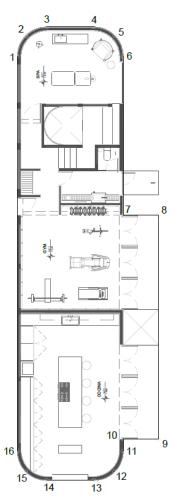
Plano de construcción cocina, spa y Gimnasio.
